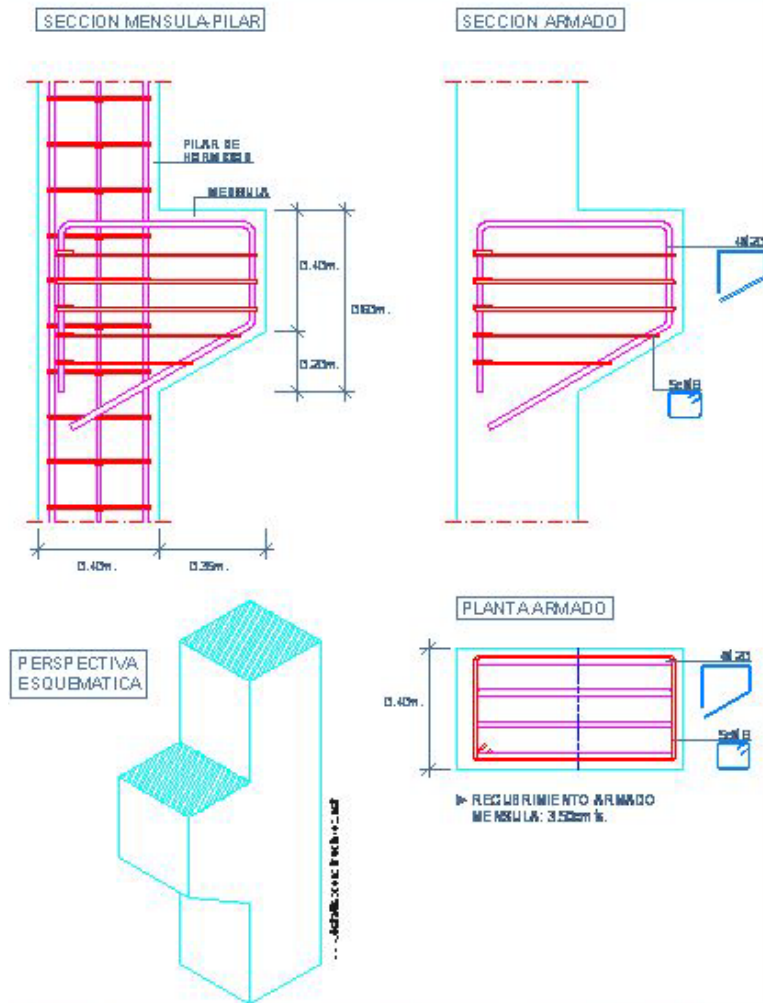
Detalle de ménsulas de hormigón armado (2018)
